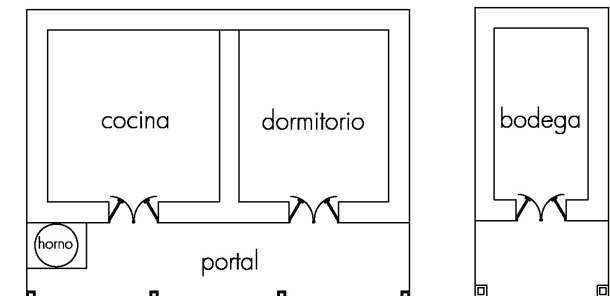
Planta Baja y Planta de Sótano. Tipología 2.
